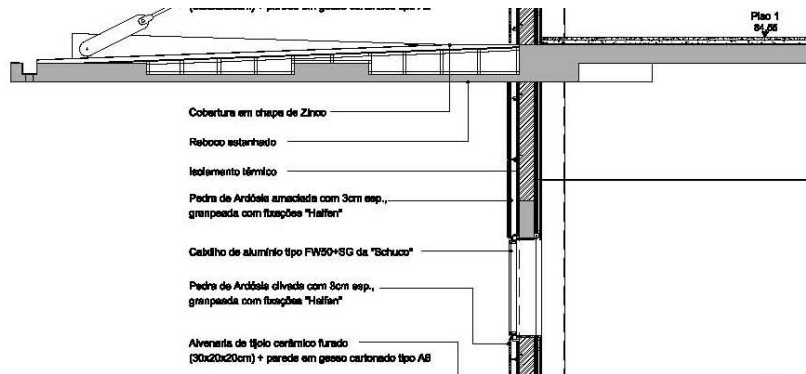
Pormenor construtivo da parede exterior; Fonte: MAPEI/ Ordem dos Arquitectos
